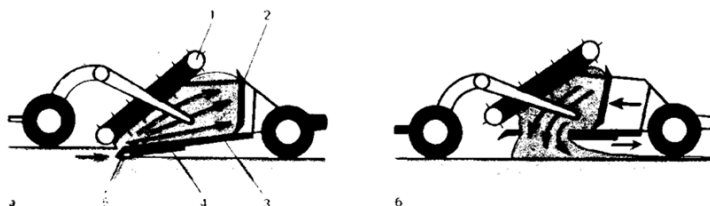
Схема скрепера с элеваторной загрузкой: а-загрузка; б- разгрузка, 1-элеватор; 2- задняя стенка; 3- днище; 4-откатное днище;5-ножи.
